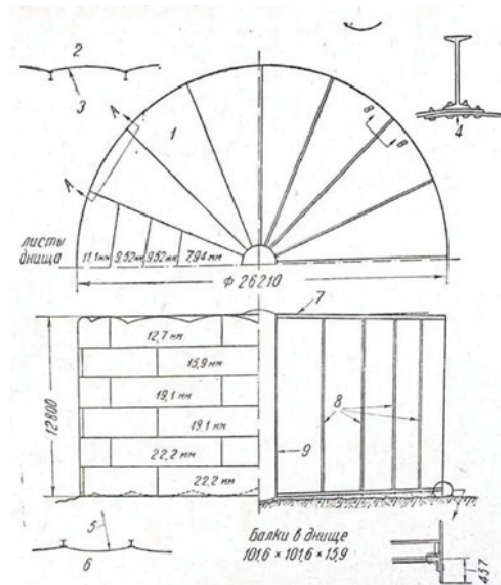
Устройство крыши резервуара с радиальными стропилами сверху и радиальными балками
